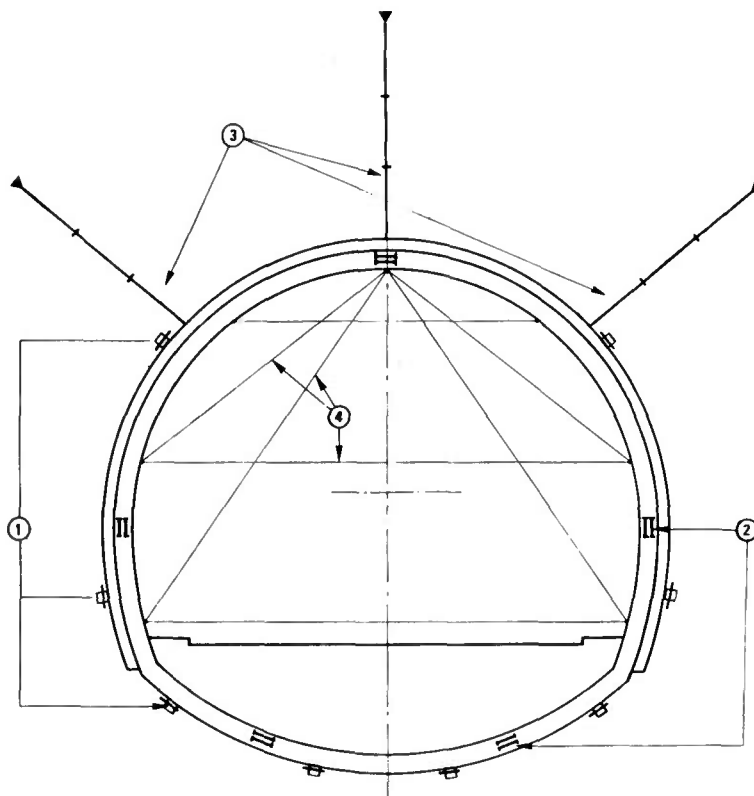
Autoroute A. 8. - Tunnel de la Baume.
